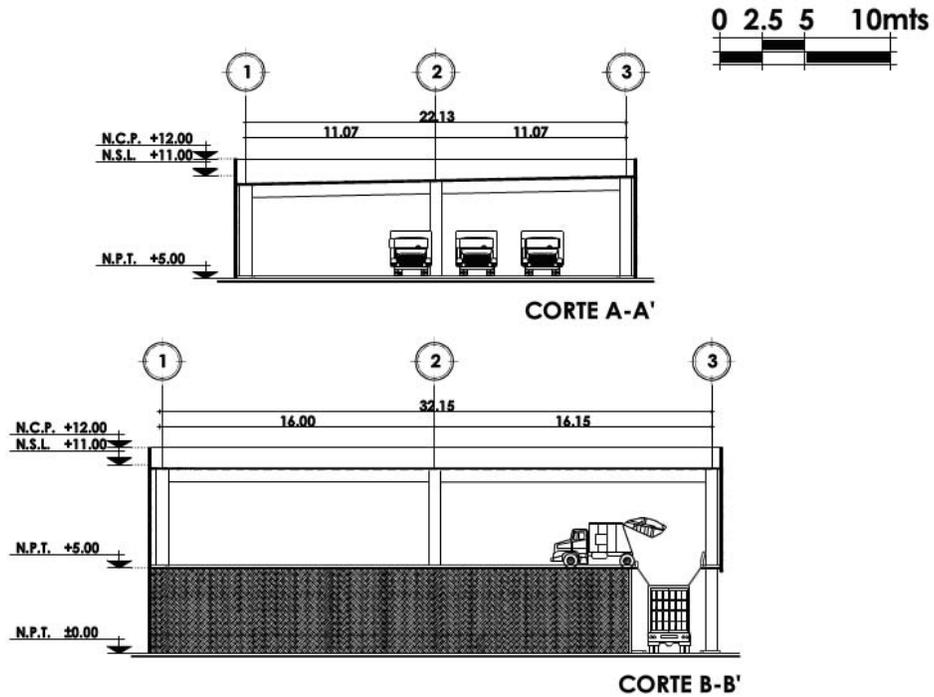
Planta arquitectónica, estación de transferencia (patio de maniobras, corte)
